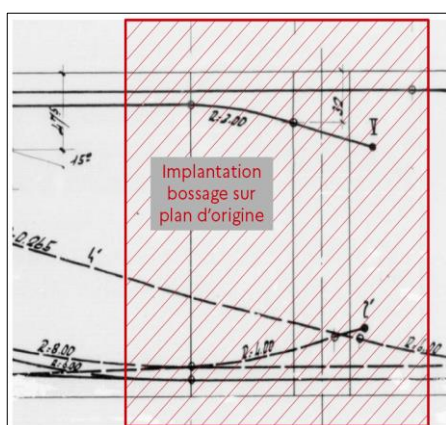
Implantation d'un bossage d'ancrage sur le plan d'origine
